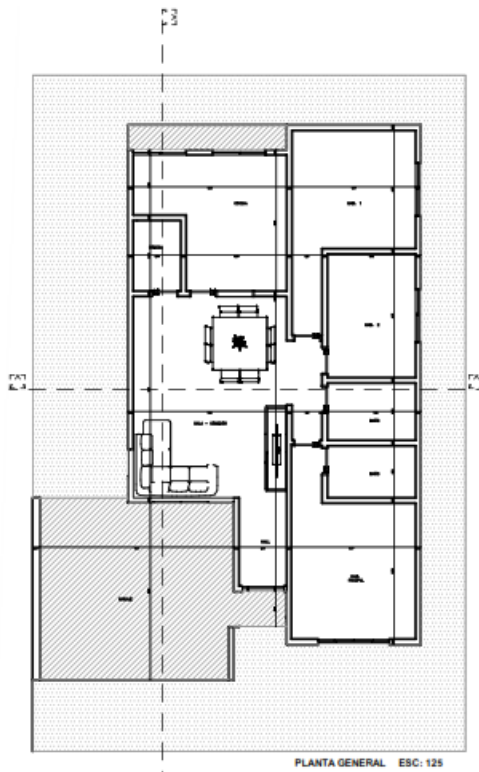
Vista en planta propuesta de vivienda número dos.
